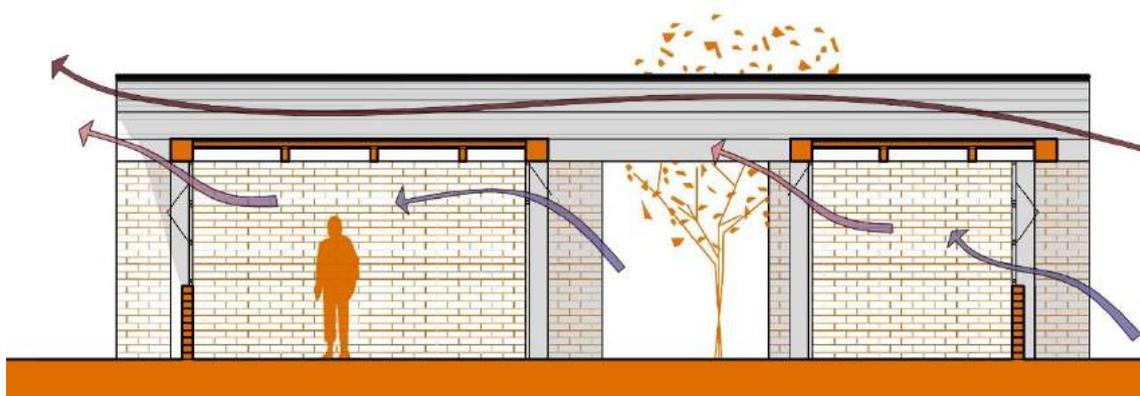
Sección vivienda tipo. Fuente: Elaboración propia
